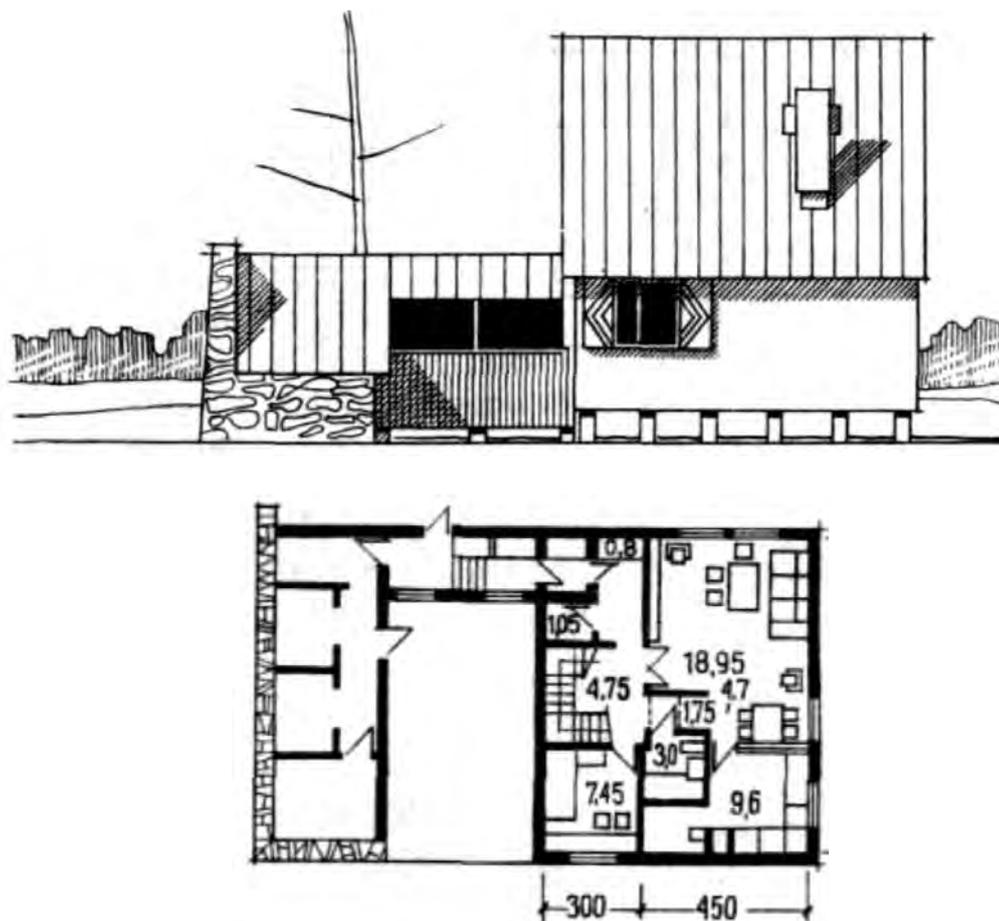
Одноквартирный дом для Крайнего Севера. Типовой проект. Фасад, план
